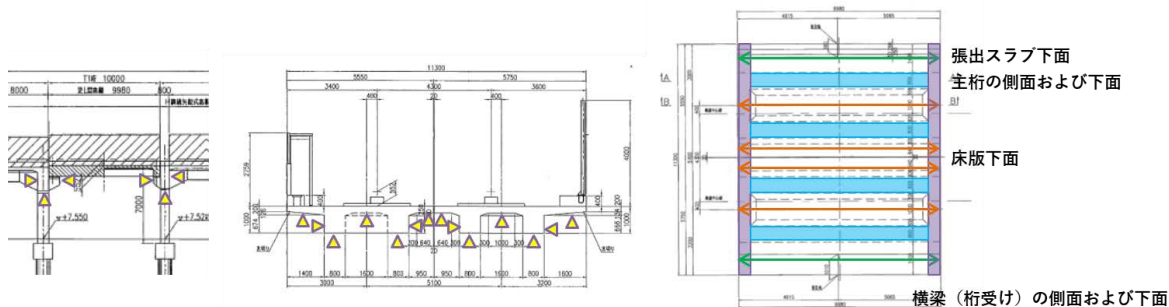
桁構造 かぶり測定対象部位 (左：縦断面図, 中央：横断面図, 右：下面平面図)
